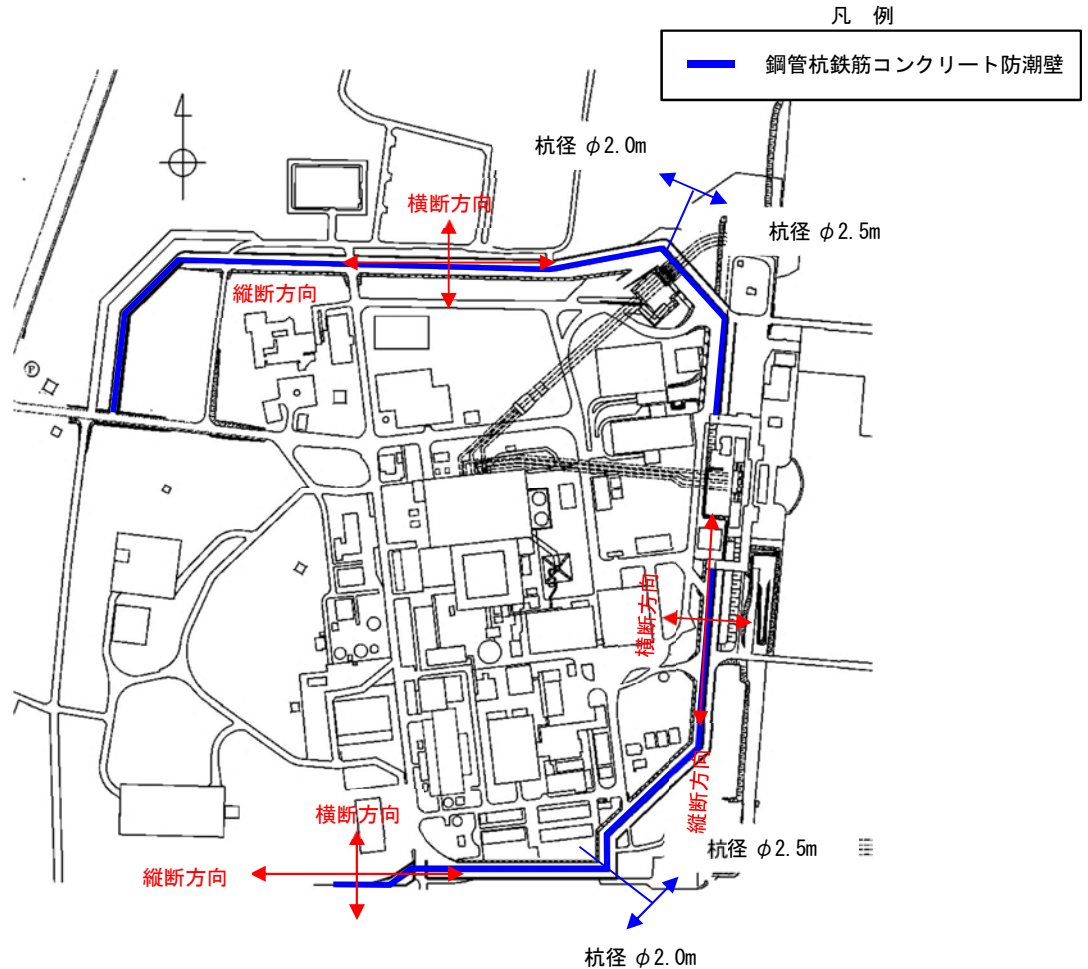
鋼管杭鉄筋コンクリート防潮壁の平面配置図
